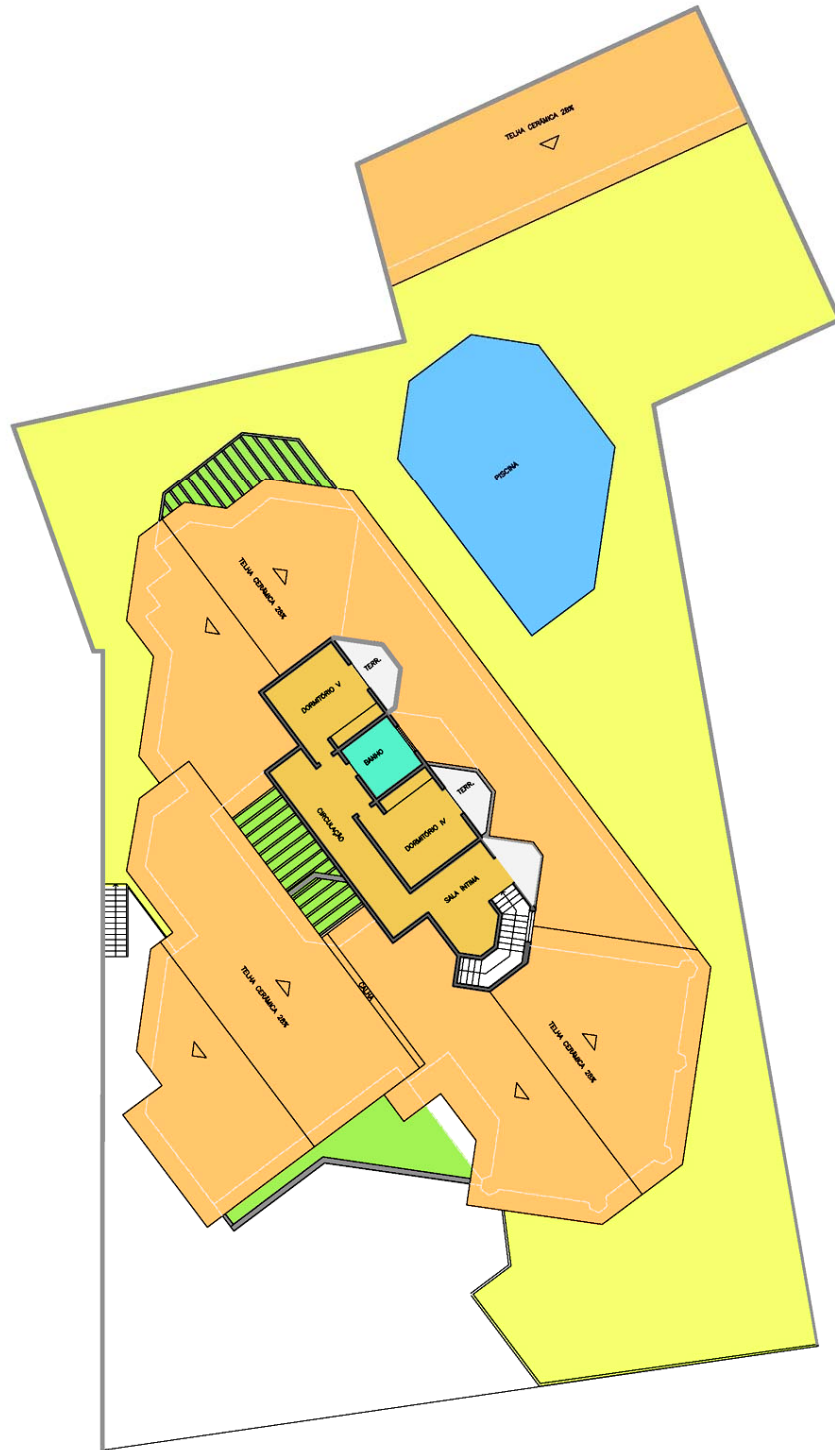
Planta digitalizada do pav. superior – nível +6,60 m (2006)
